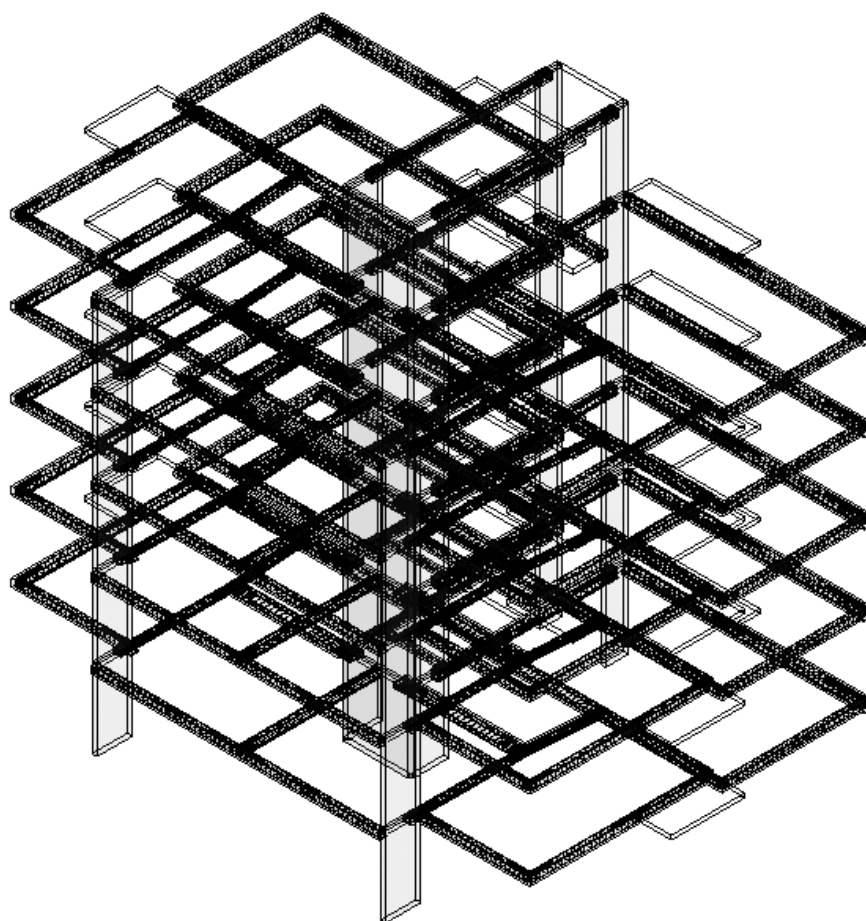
Vista 3D de todos os modelos de armaduras de vigas
